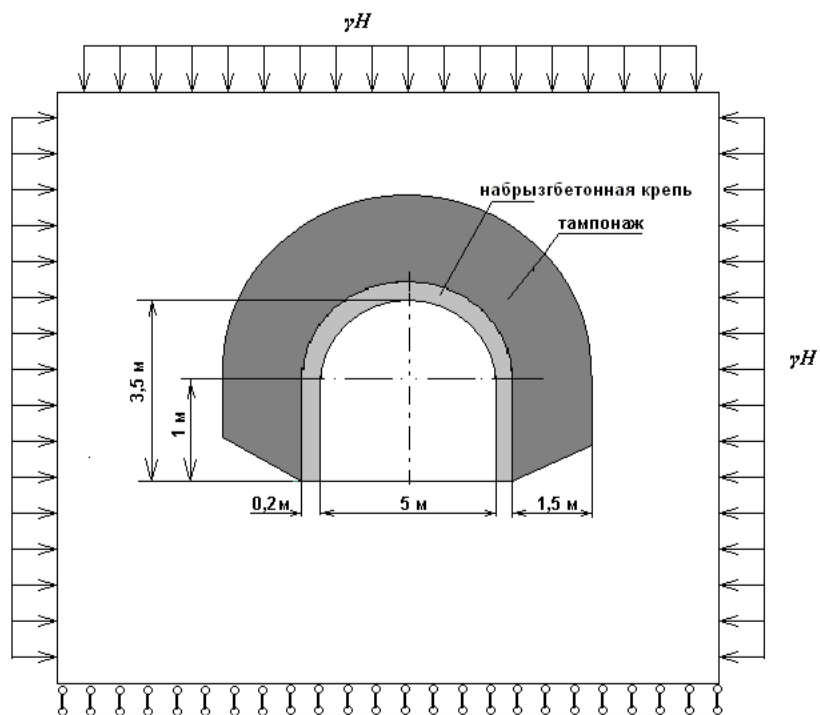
Расчетная схема выработки с набрызгбетонной крепью, толщиной 20 см и тампонажем закрепного пространства на глубину 1,5м.
